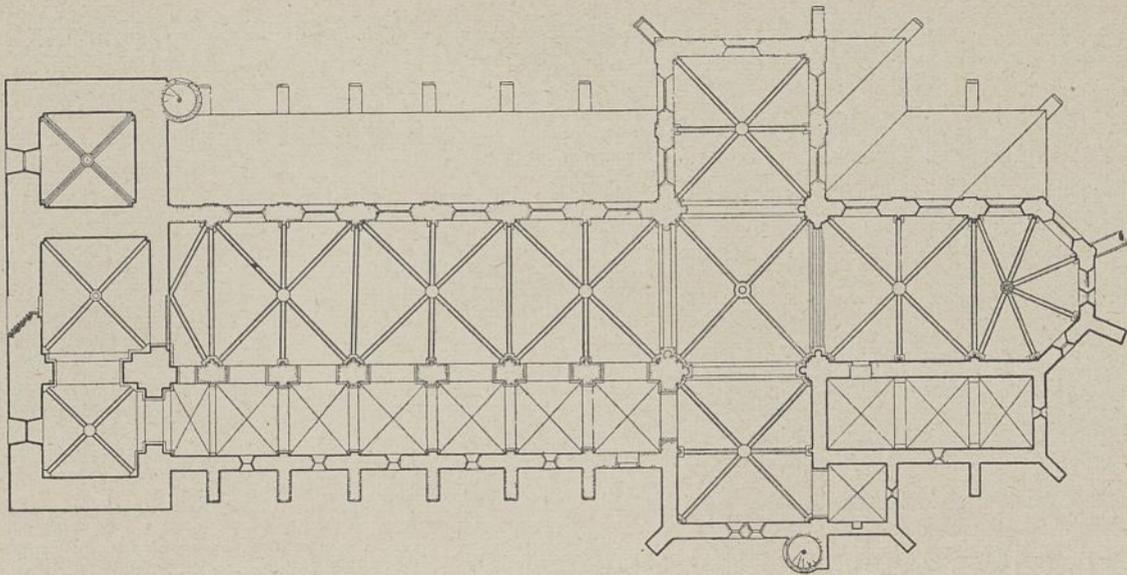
Grundriß vom früheren Zustande. M 1:400.
